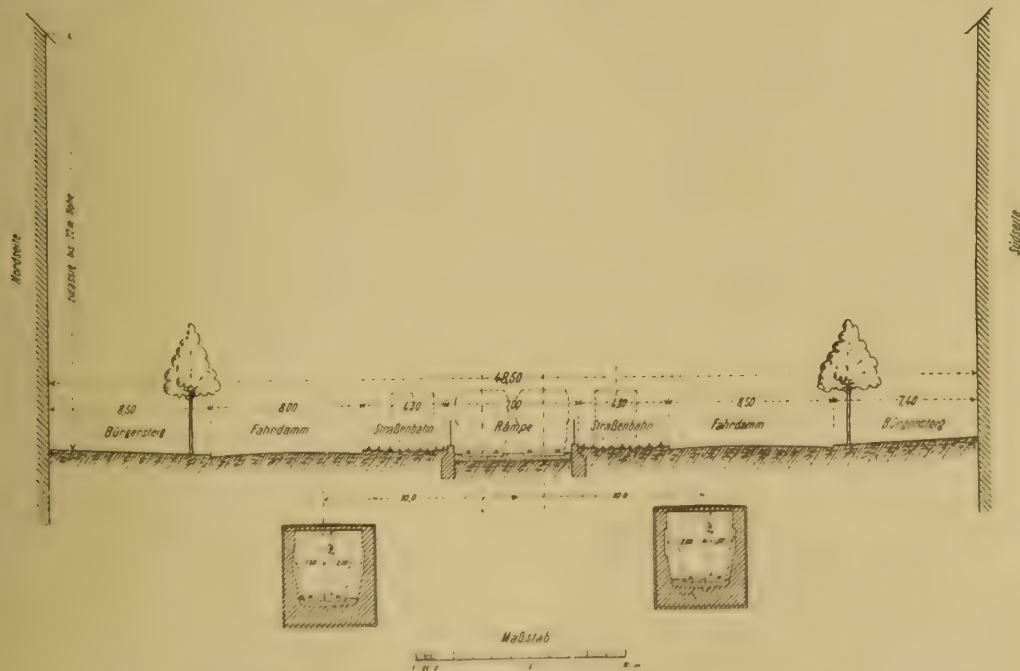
Kleiststraße mit Rampe und Untergrundbahn.
